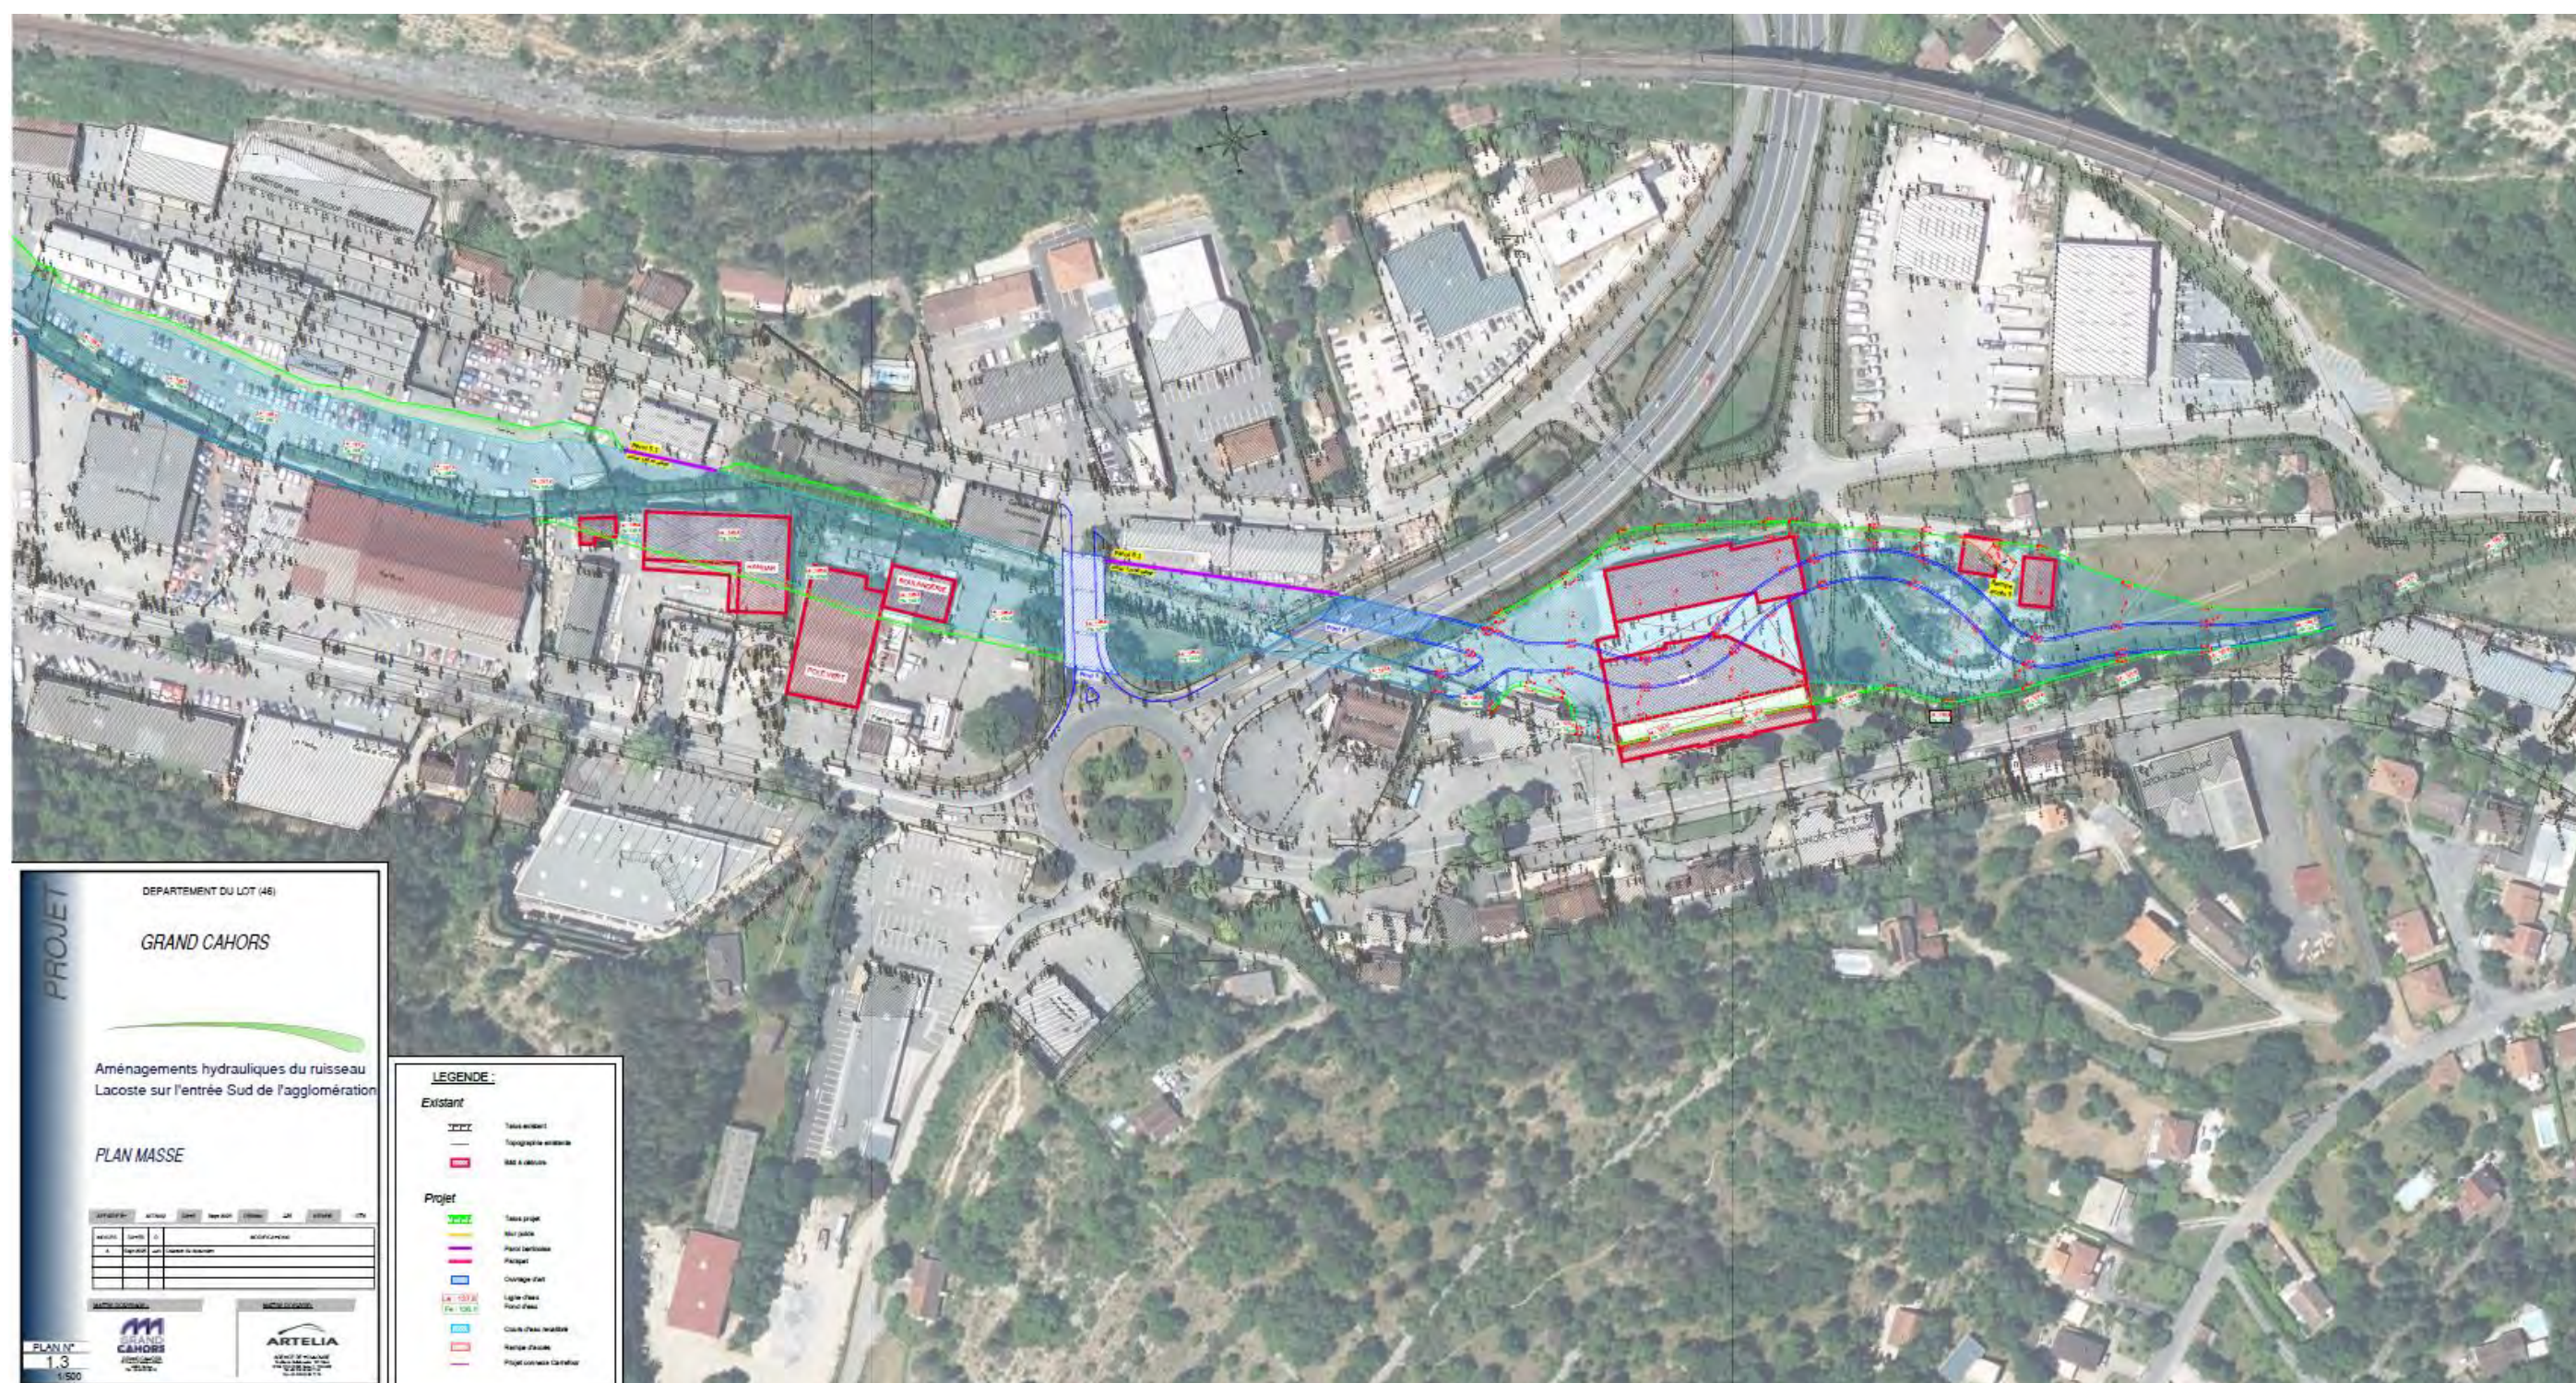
Plan des aménagements projetés – Planche 3 sur 3
